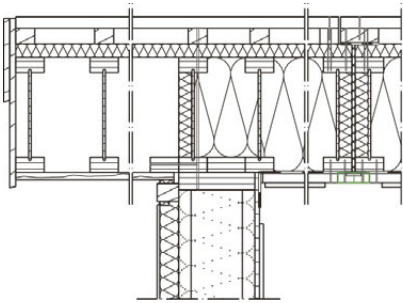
Osadzenie kolejnego elementu prefabrykowanego.
